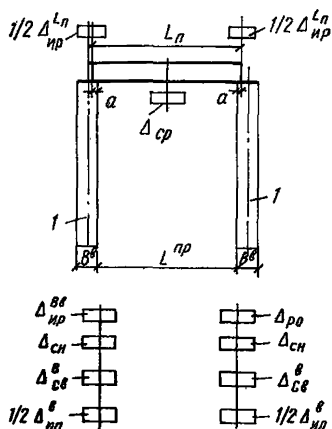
Схема полей допусков для определения длины опирания панели перекрытия на панели внутренних стен
